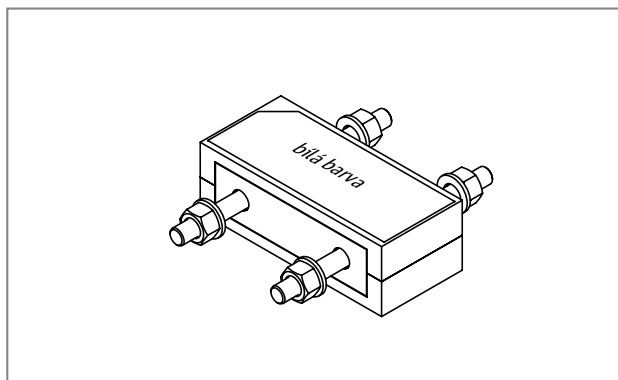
Schöck Isokorb® T typ S-N-D22: Řez prvkem
